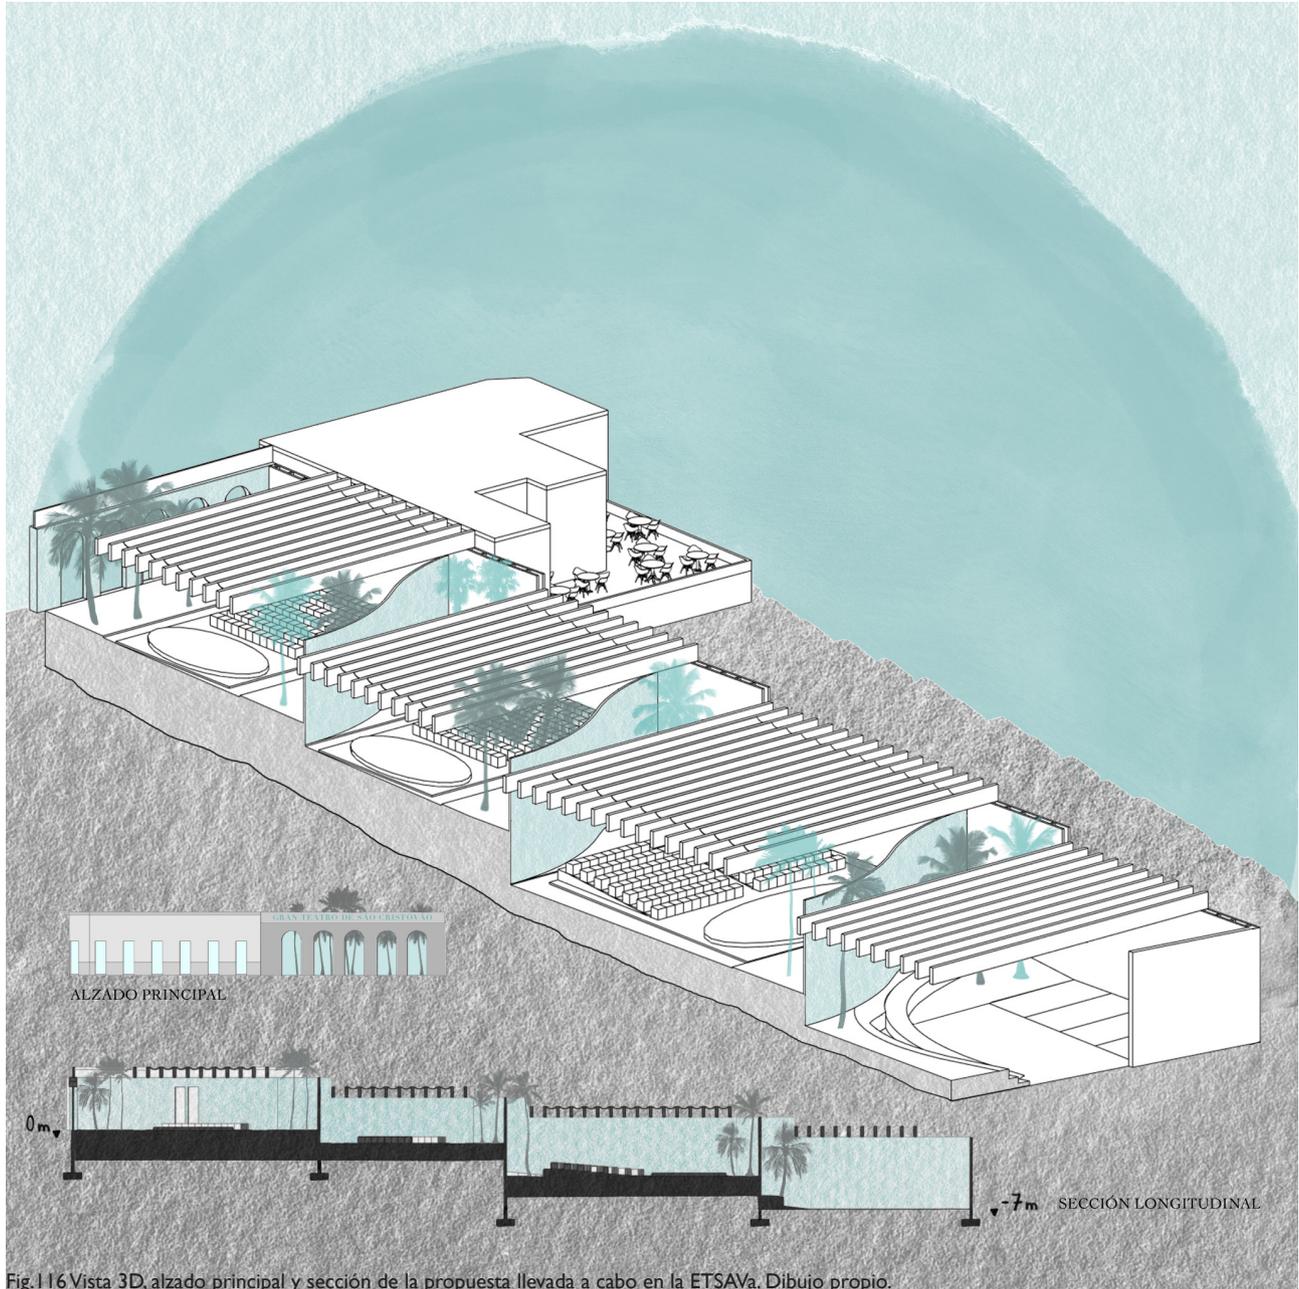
Vista 3D, alzado principal y sección de la propuesta llevada a cabo en la ETSAVa, Dibujo propio.
